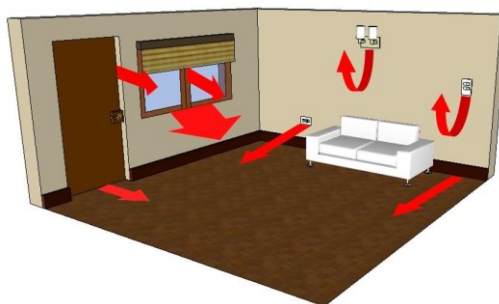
Esquema de infiltraciones de aire por puerta, ventana, luces, enchufe y zócalo (Navarrete Boutaud, 2016)
